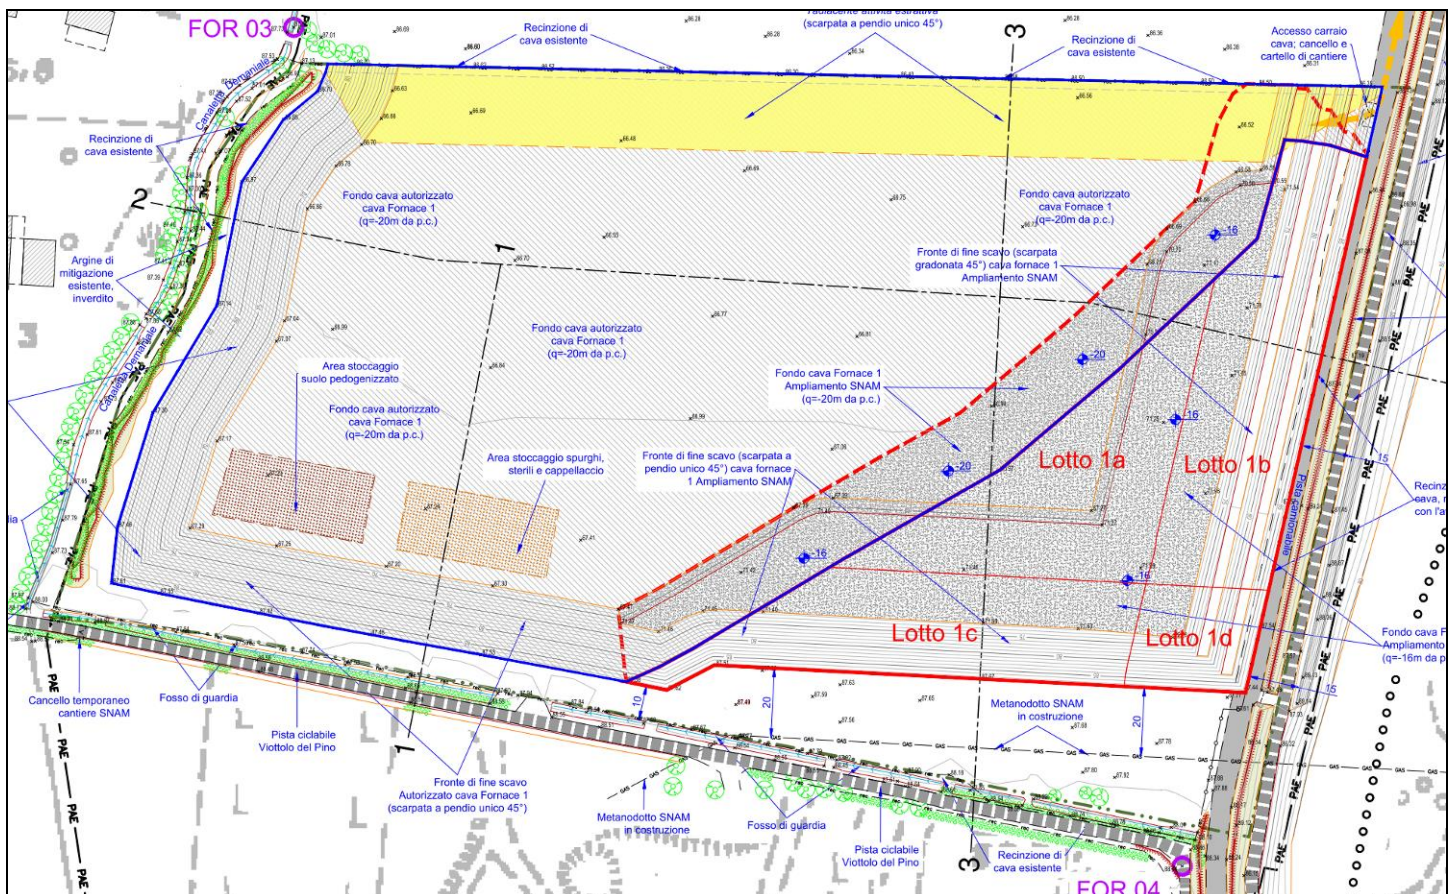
Stralcio della Tav. 07 “Progetto - Planimetria di massimo scavo”.
